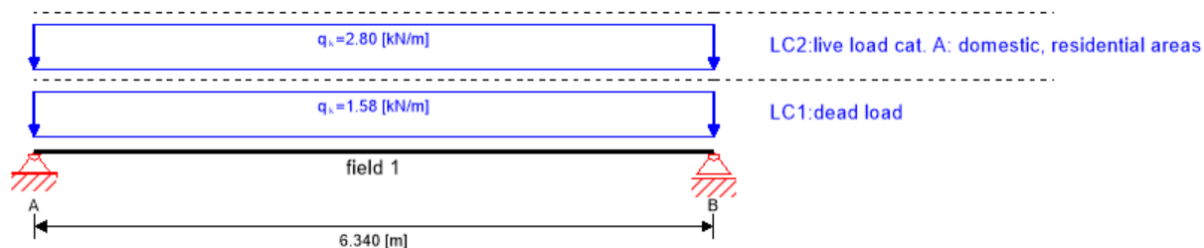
Sistema estrutural para verificação dos painéis CLT de piso
